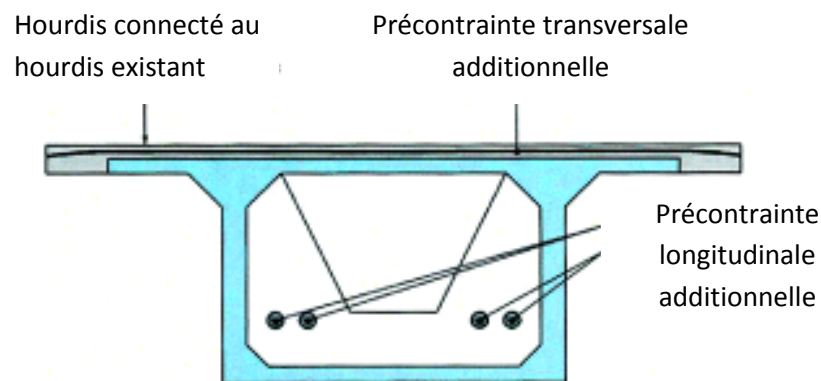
Pont à poutre-caisson renforcé par précontrainte longitudinale et transversale suite à l'élargissement de la dalle de couverture [1]
